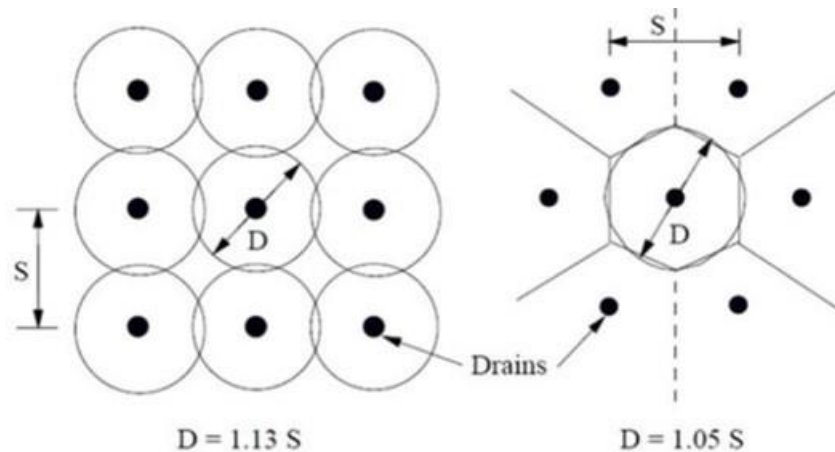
Distribución en planta de drenes verticales (Indraratna y Bamunawita, 2005)
